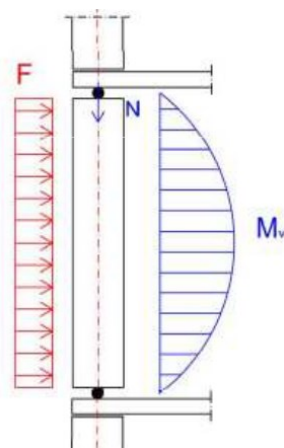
Modello semplificato di verifica delle pareti fuori piano
